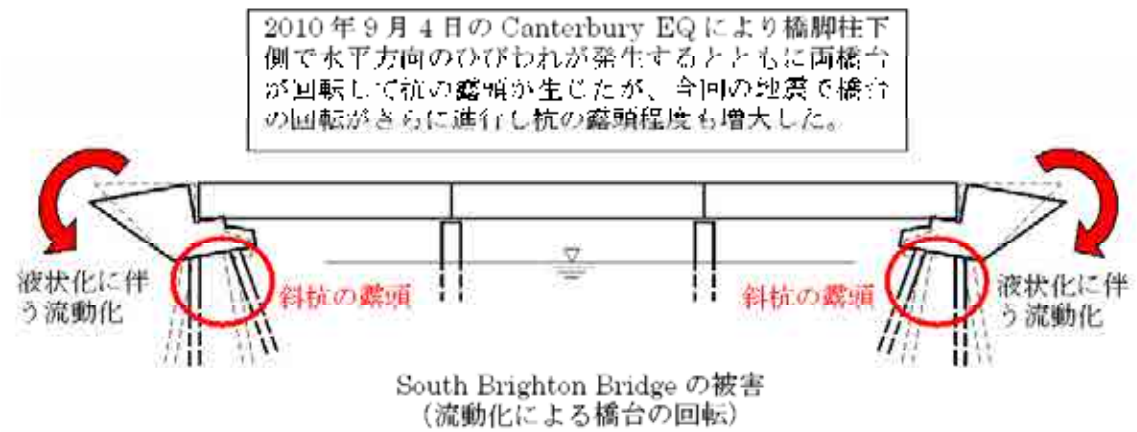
South Brighton Bridge の損傷状況 (橋台回転変形)
